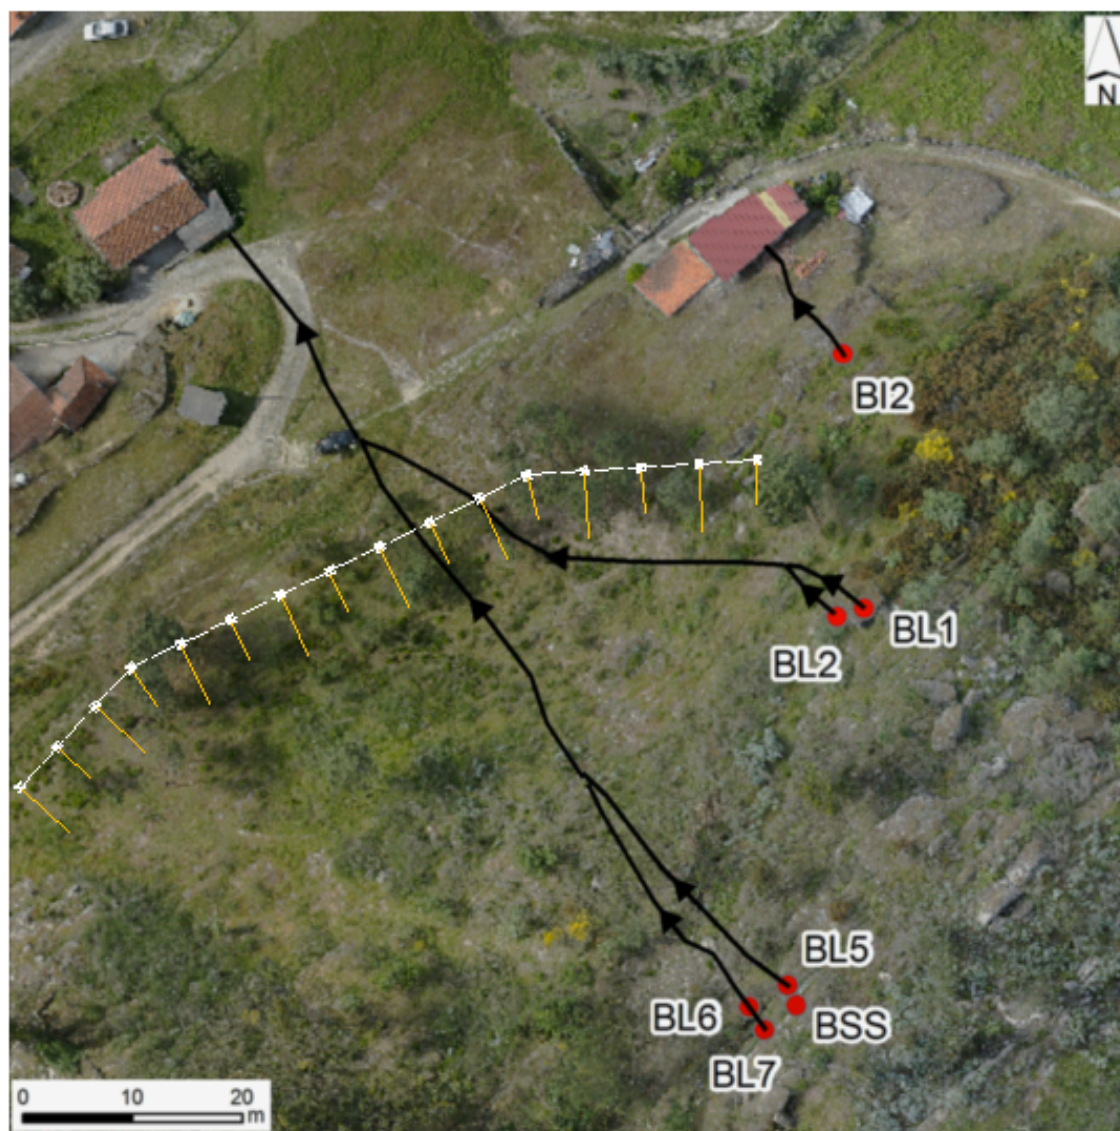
Vista em planta das barreiras flexíveis na vertente de S. Simão.
